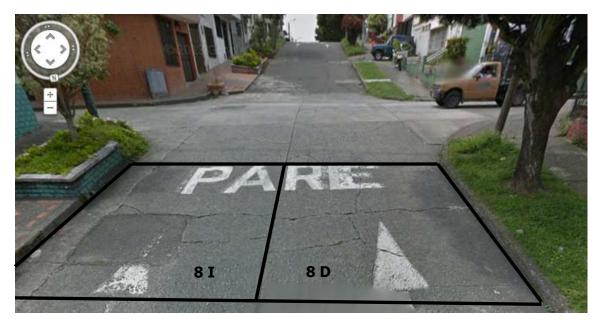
Tramo vehicular C 5 (Cl 23 entre Cra 19 y Cra 19 Bis) pavimento rígido.
